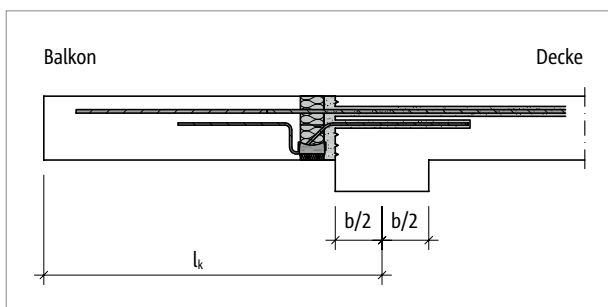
Schöck Isokorb® RT Typ K: Statisches System; indirekte Lagerung
